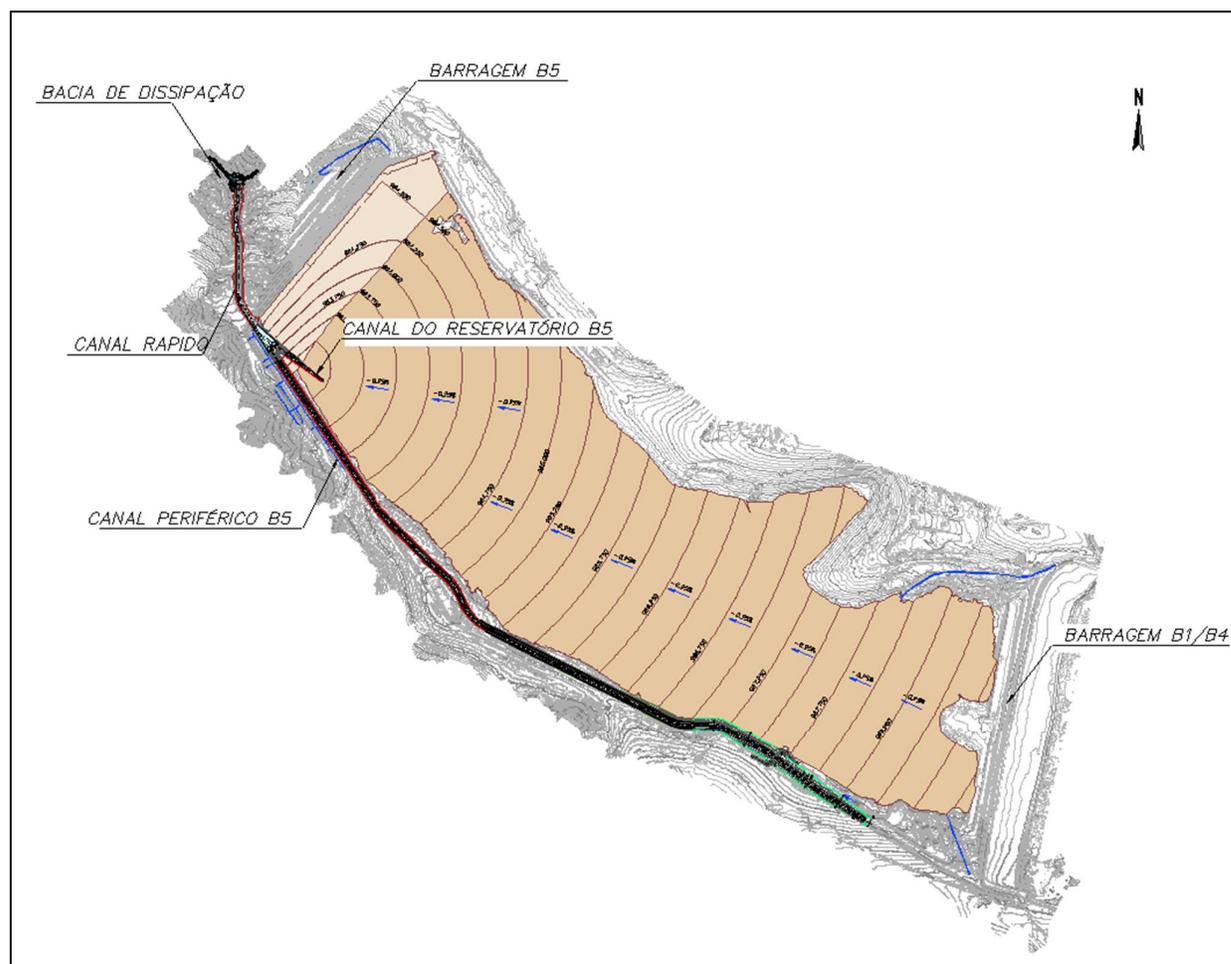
Arranjo geral das estruturas de drenagem superficial propostas para o projeto.
